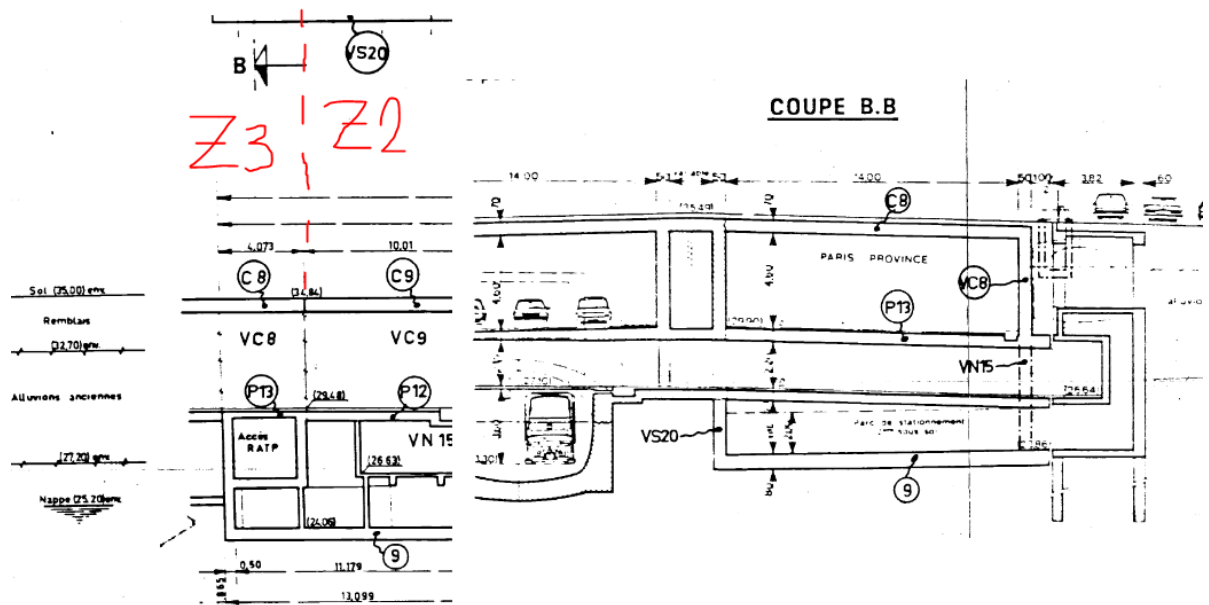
Coupes transversale et longitudinale de la fin du parking en dessous de la zone 3\_plan 171234
